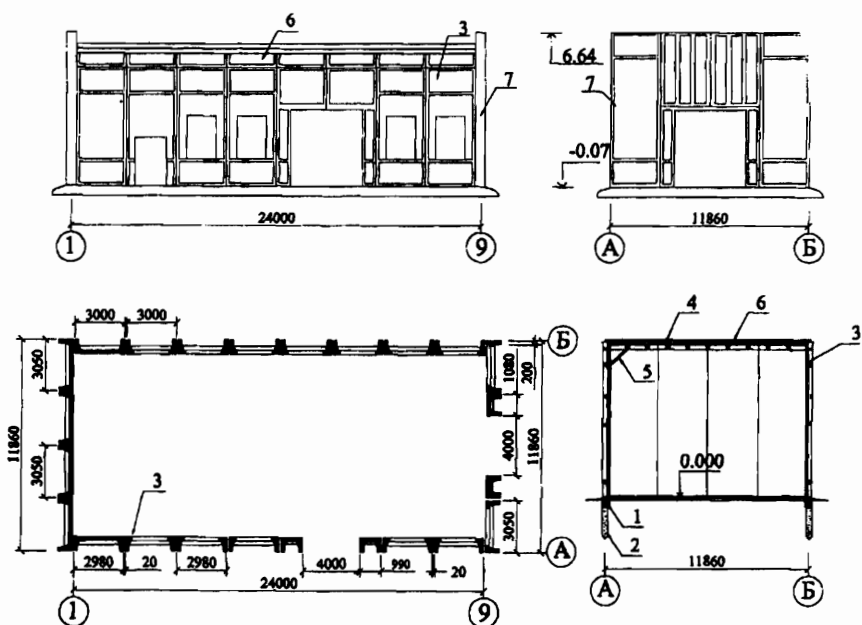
Конструктивно-технологическая схема одноэтажного однопролетного БМЗ: 1 - свайный фундамент; 2 - монолитный ростверк; 3 - панели наружных стен; 4 - панели покрытия; 5 - раскос; 6 - фризная панель; 7 - торцевые панели
